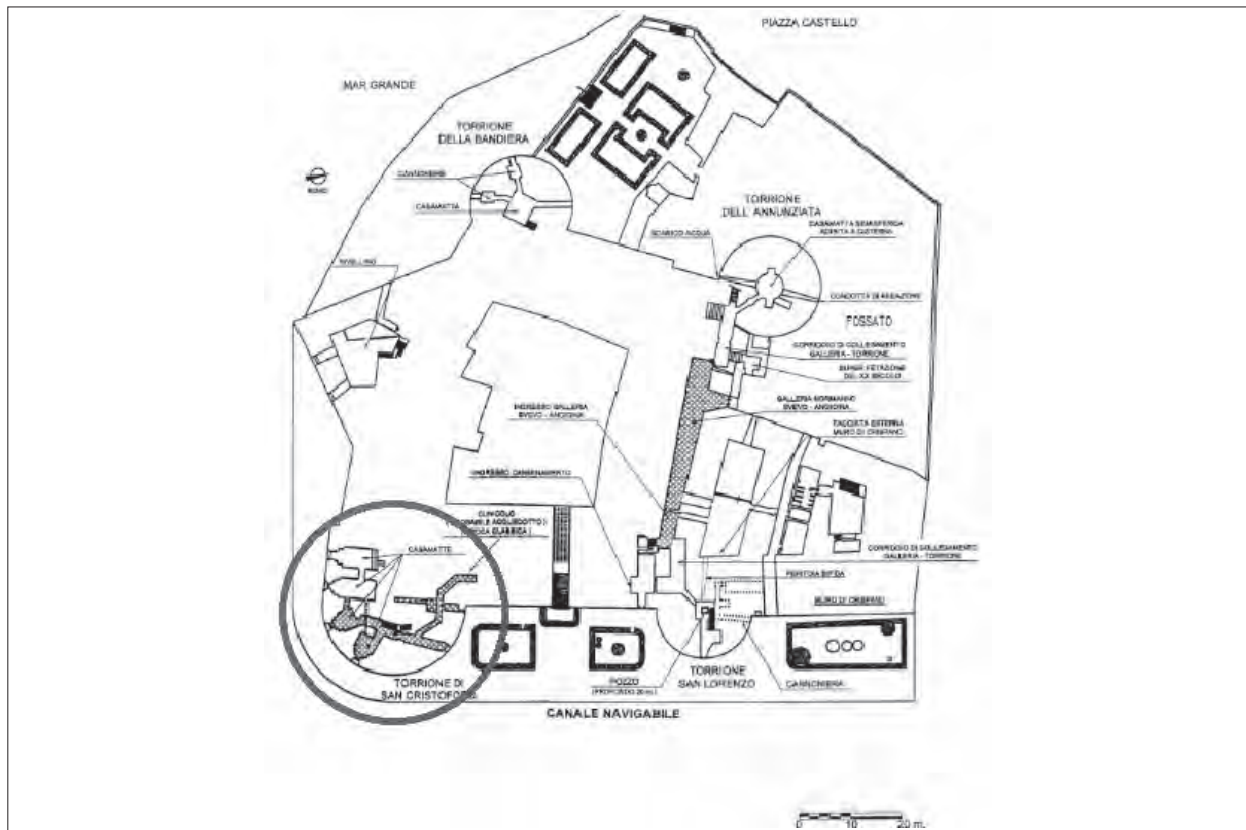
Planimetria del Castello Aragonese, in evidenza l'area di scavo
